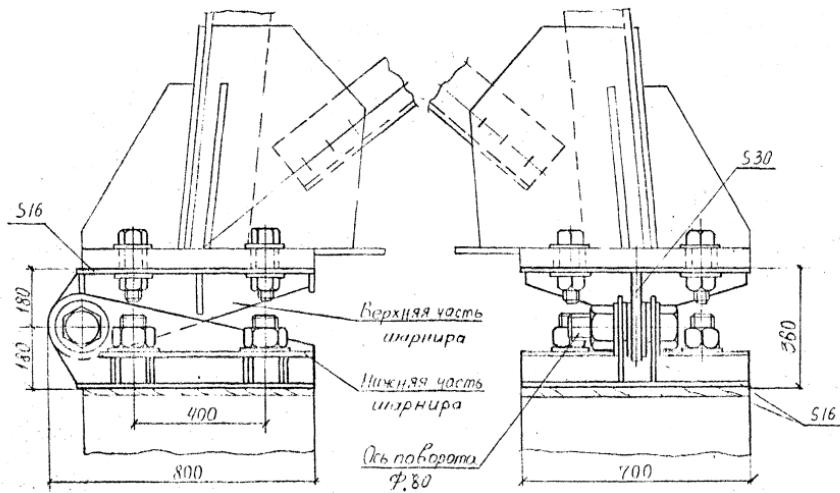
Вариант закрепления опоры на фундаменте с анкерными шпильками
